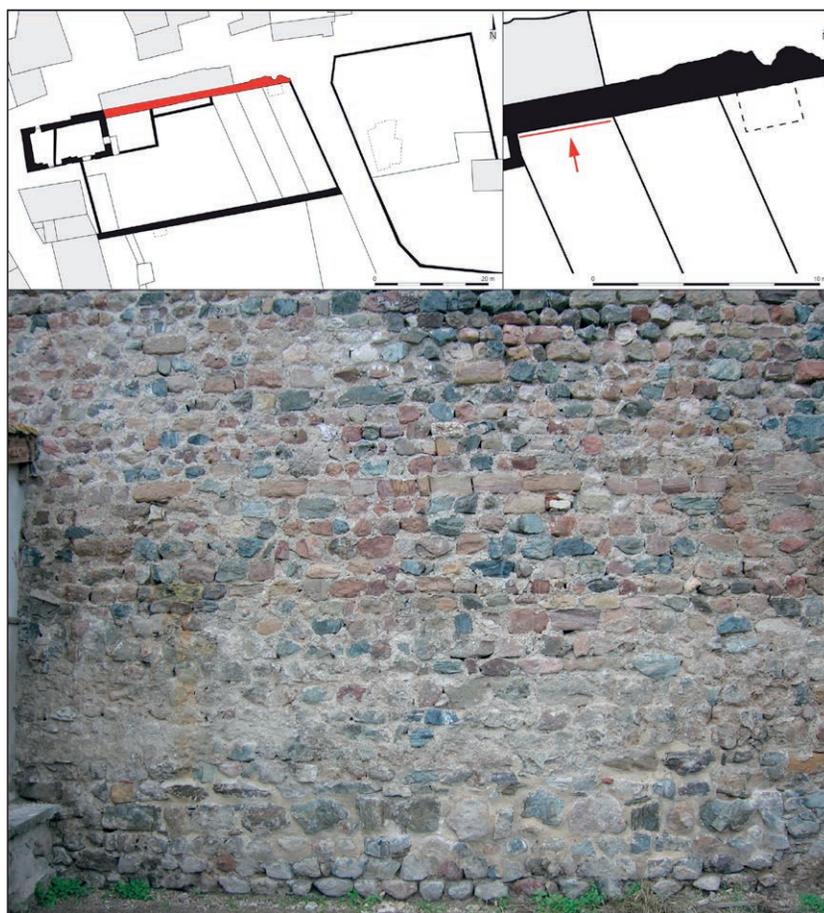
Emprise de la nef, étude du bâti sur le parement interne du mur gouttereau nord : détail de la maçonnerie M 3, appuyée sur la harpe d'attente de la maçonnerie antérieure (cl. Olivia Puel, 2009).
